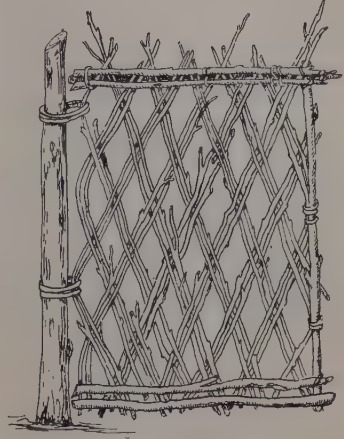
Tür einer Eingangshalle in Sutura. Höhe etwa 1,80 m.
